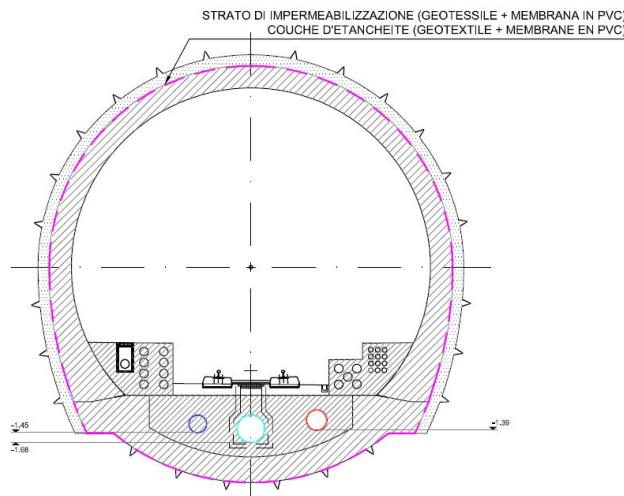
Impermeabilizzazione di tipo 3 per scavo tradizionale
